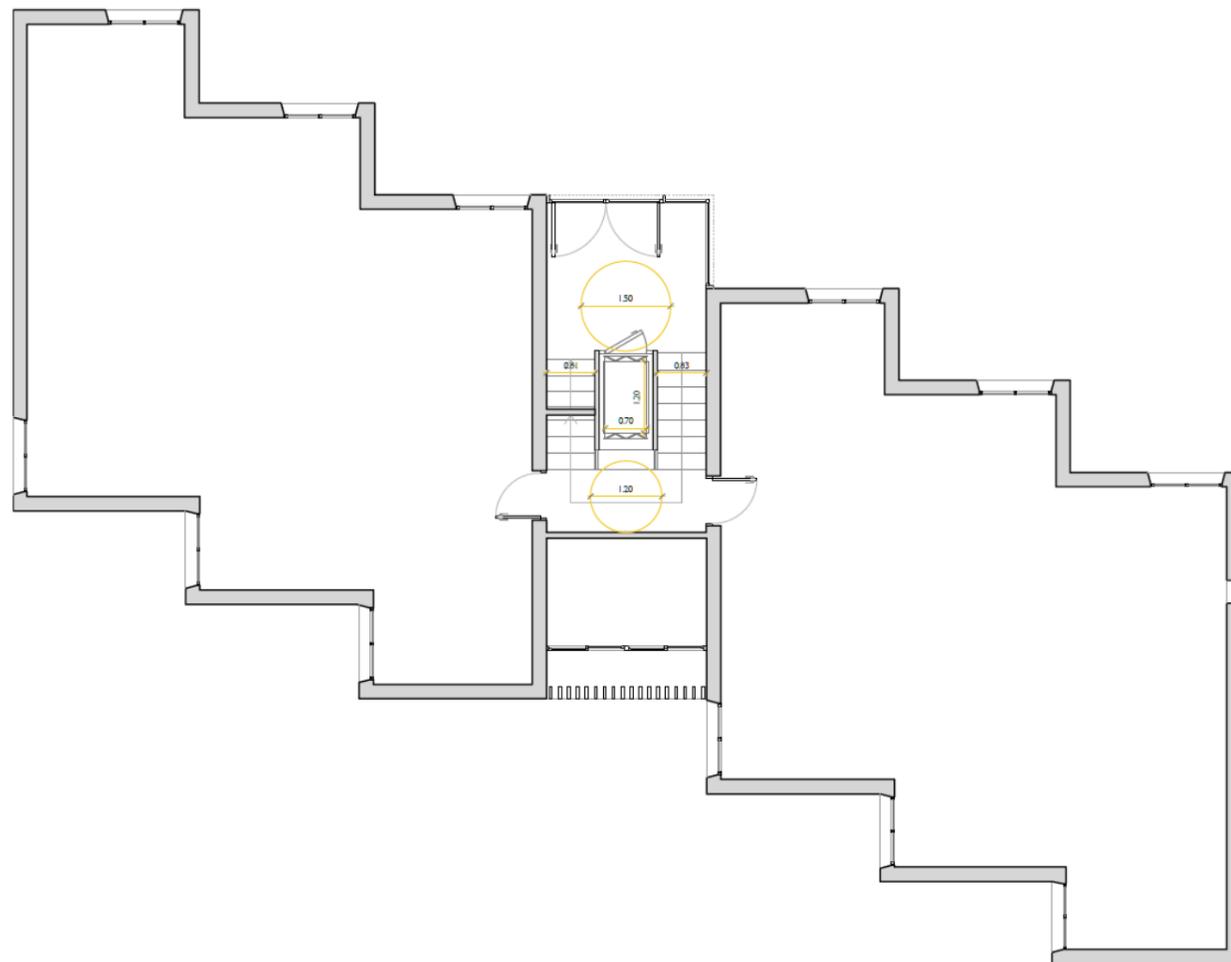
Plano zaguán. Planta semisótano. OPCIÓN 2
